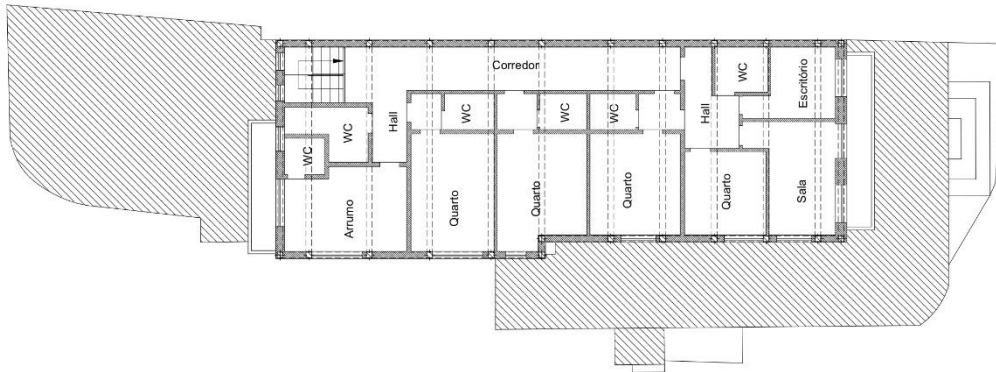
EXISTENTE | PLANTA DO PISO 1 | S/ESCALA
